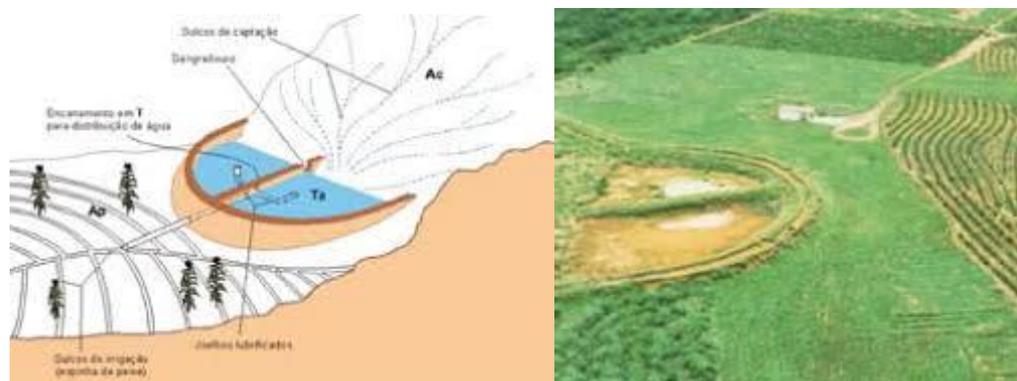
e 5: Barreiro Trincheira ou Barreiro
